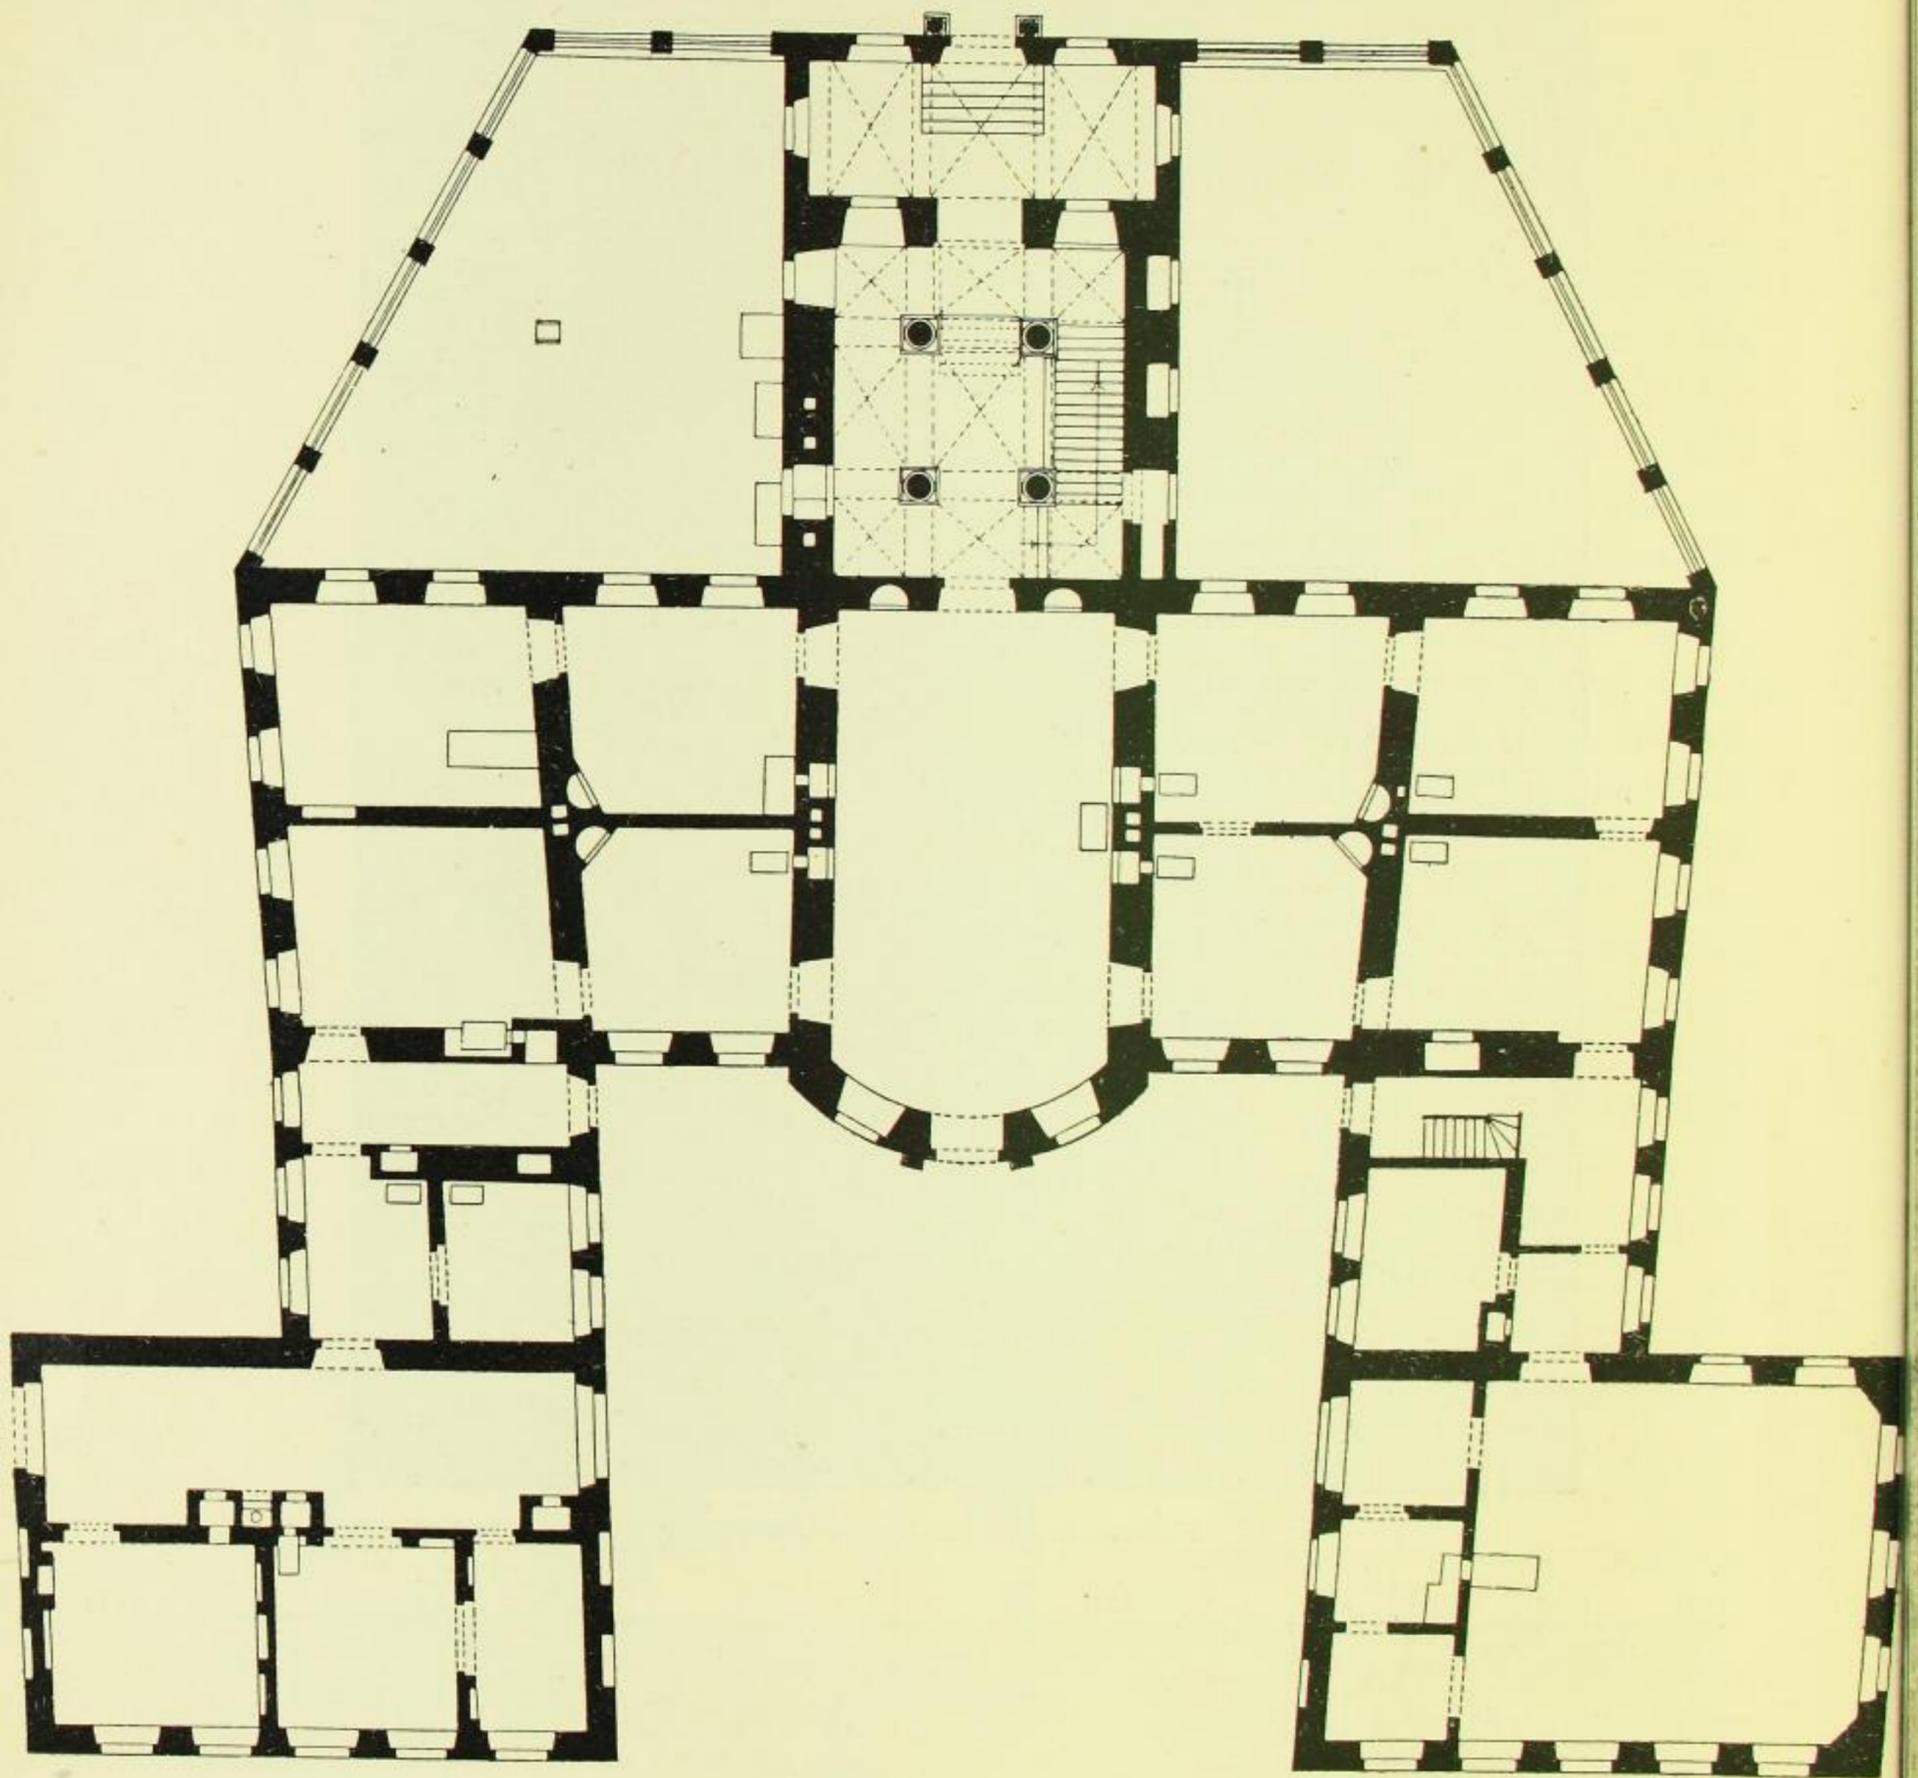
Hainewalde, neues Schloß, Grundriß des Erdgeschosses.
